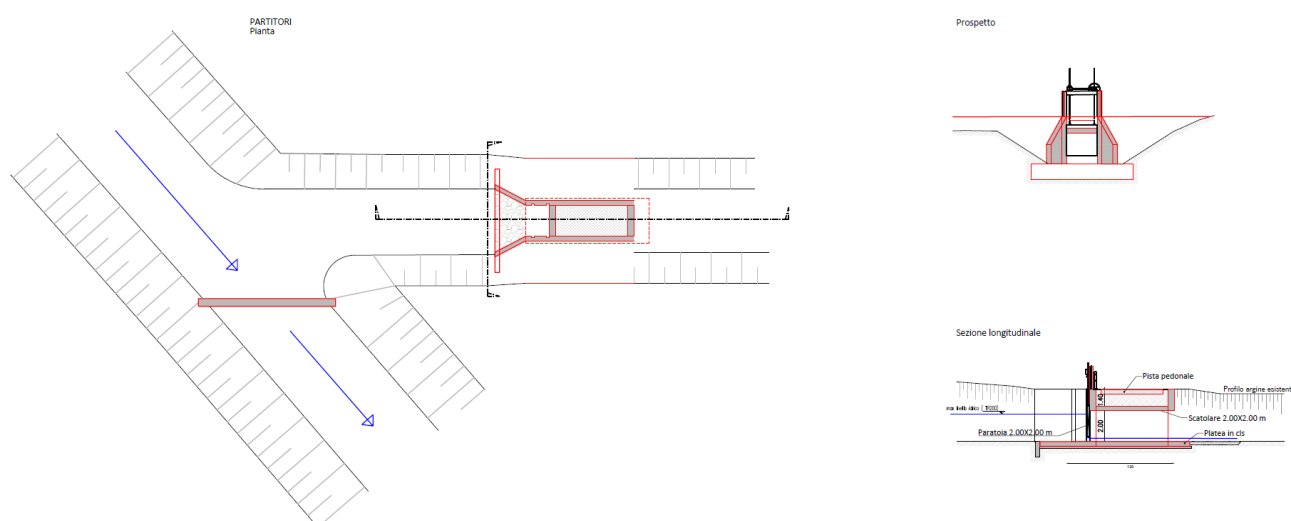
Pianta, sezione e prospetto dei partitori - stralcio elaborato grafico 5.02.44.
